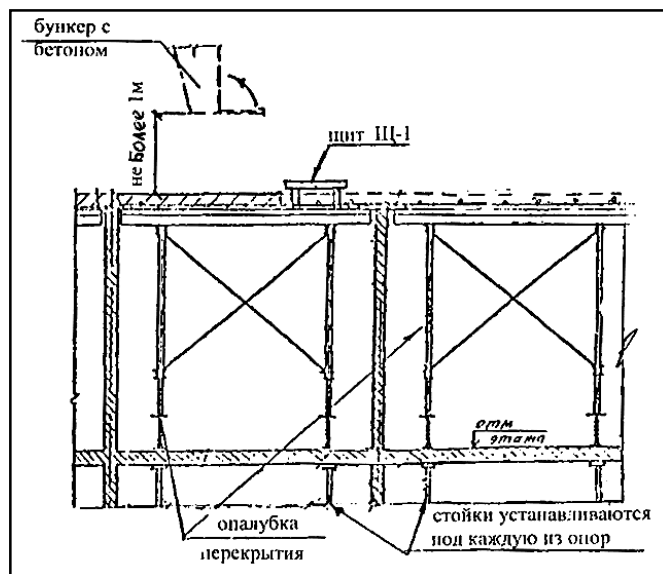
Выгрузка бетонной смеси из бункера в опалубку перекрытия
